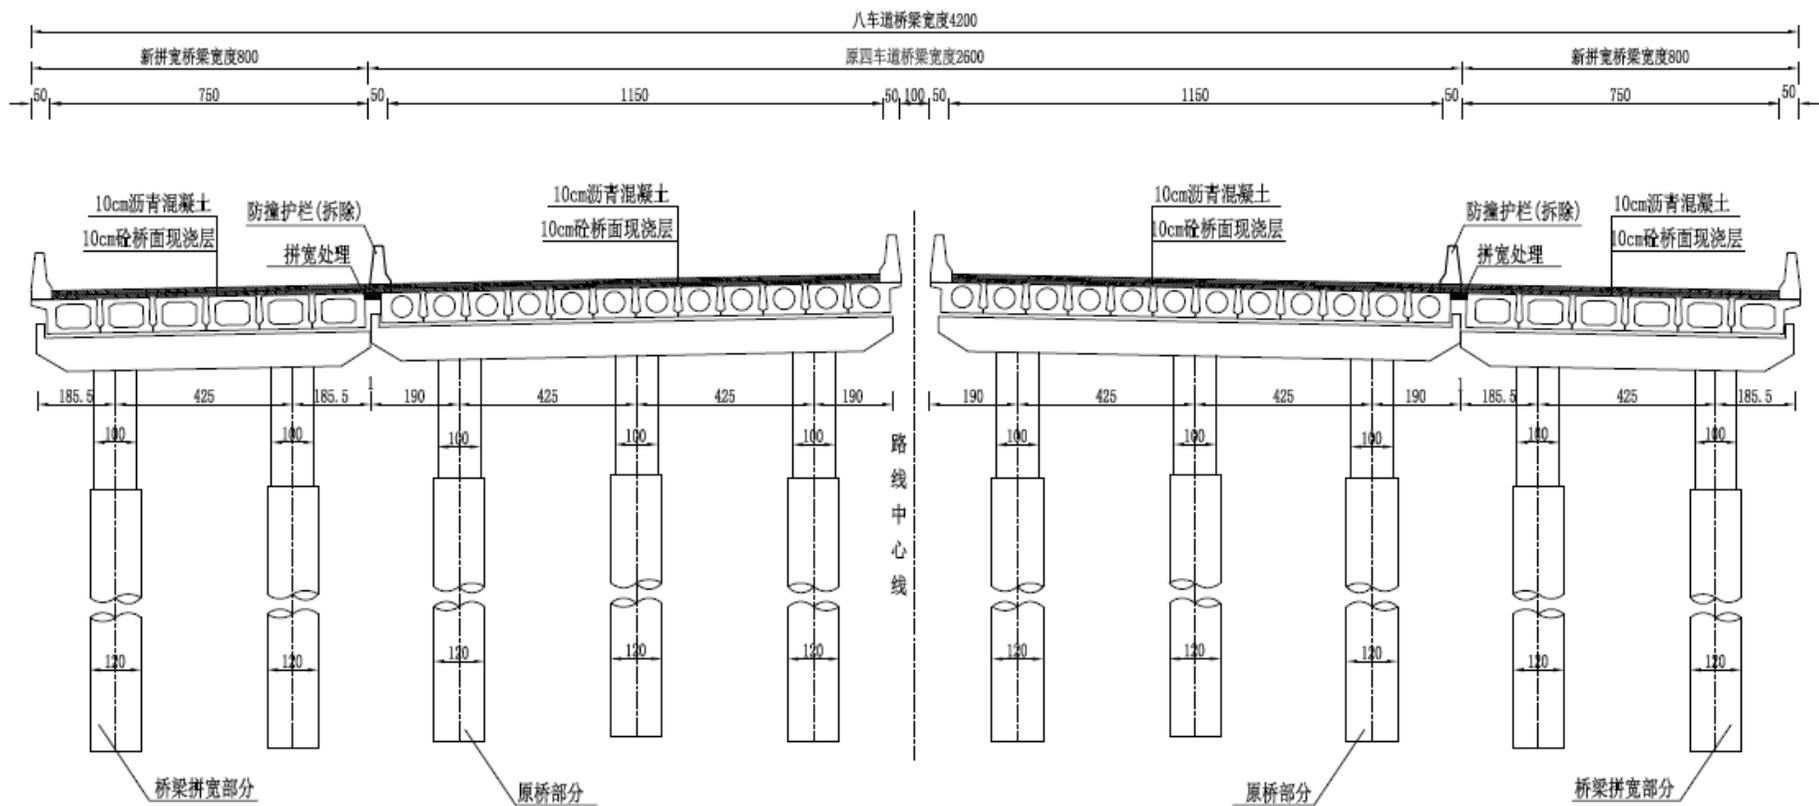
空心板桥梁加宽标准横断面图 (26m—42m)
